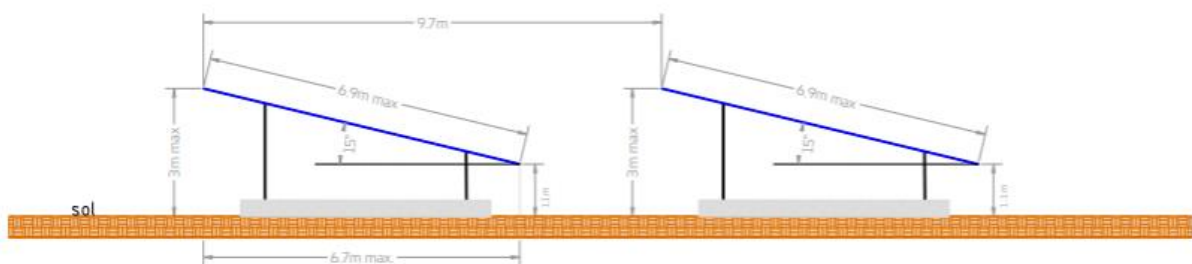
Image d'un exemple de plan de coupe d'une centrale solaire sur gabion (source : MELVAN)
